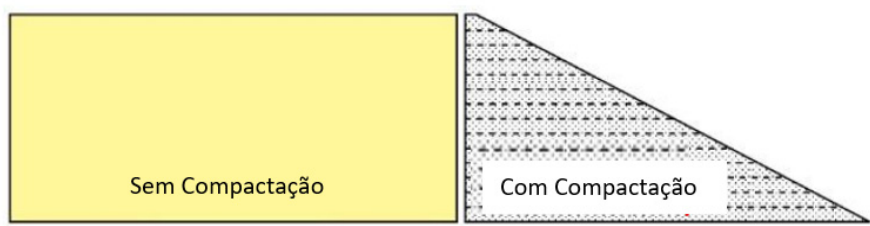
Perfil esquemático de Instalação de Rejeitados Filtrados (ICOLD, 2021)
